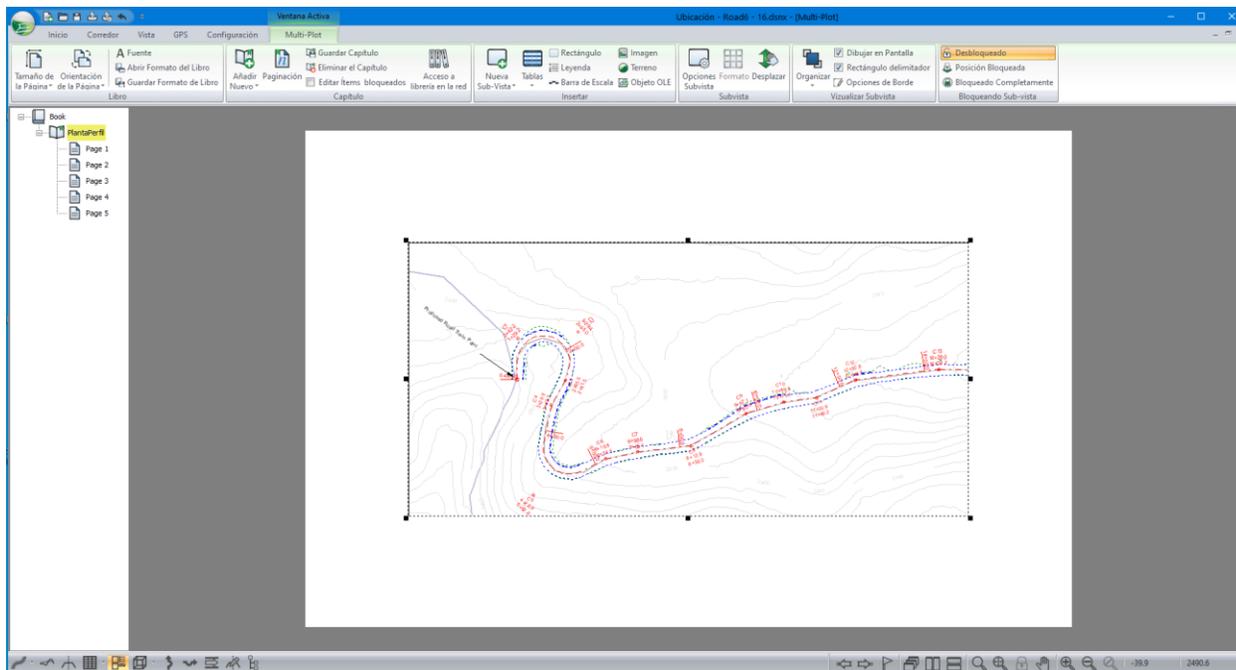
Sub-Vista Planta después de Cambio de Tamaño y Posición
